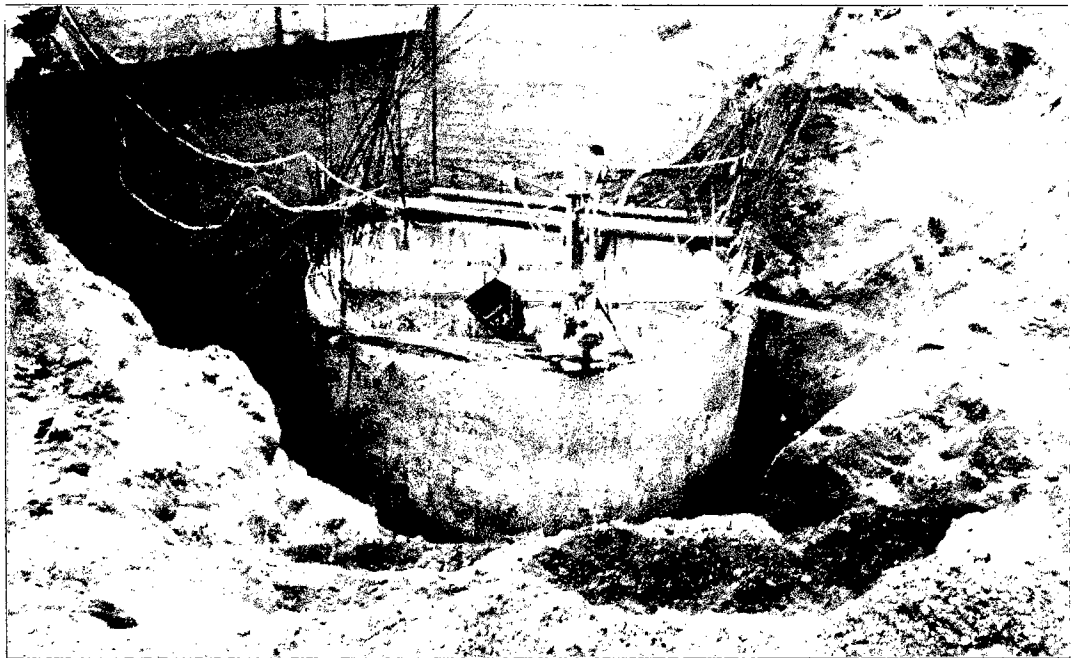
Otra vista del caisson en la que se tuvo que eliminar el terreno circundante hasta el nivel de zapata del estribo a fin de equilibrar las fuerzas laterales de empuje al caisson.
